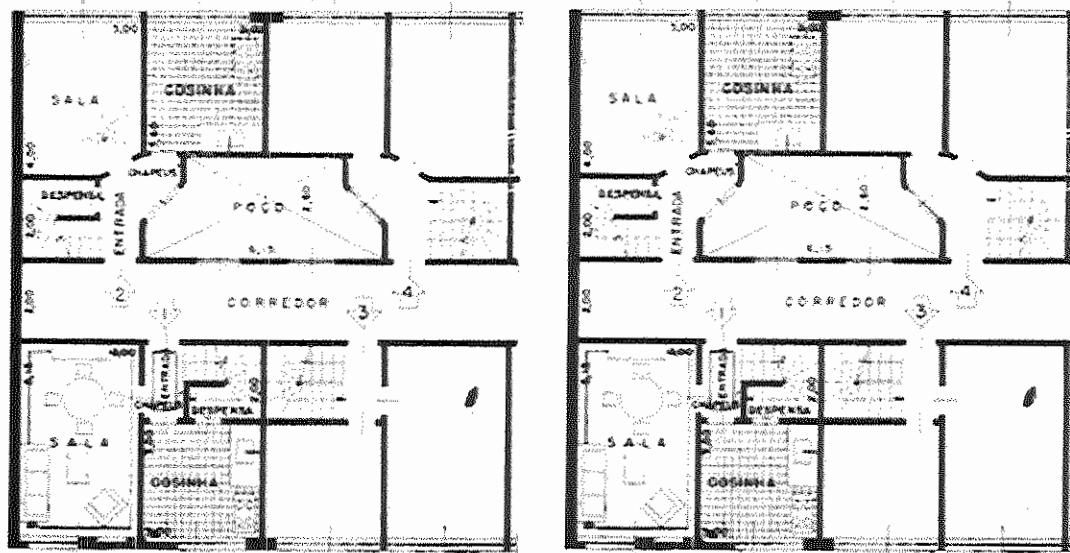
Plantas dos apartamentos do Conjunto Japurá
